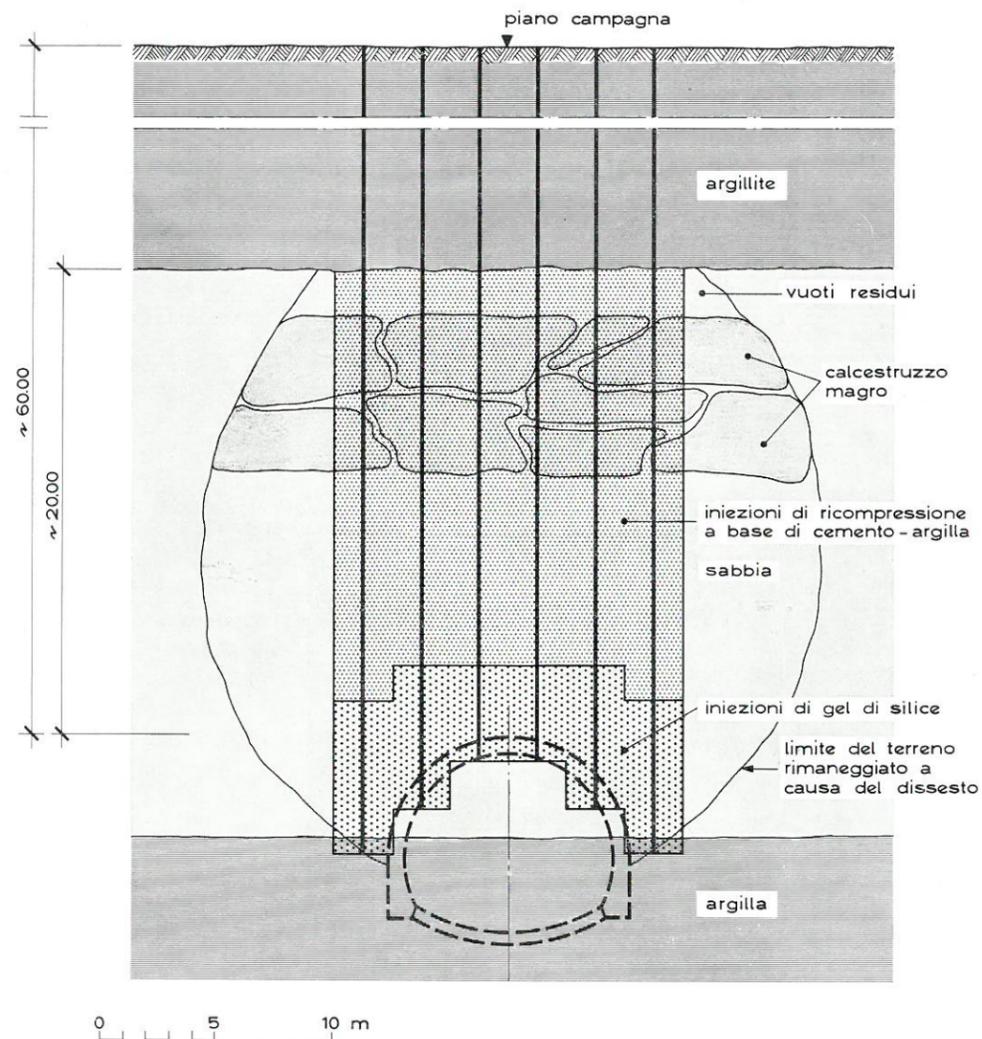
Galleria Cisterna - Particolare del trattamento di intasamento e consolidamento eseguito con perforazioni dall'esterno.
